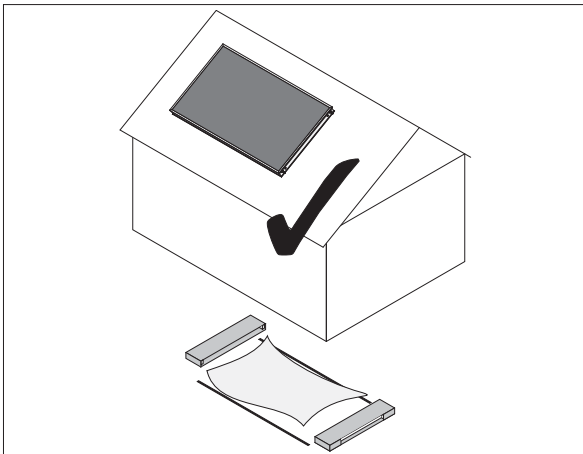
Kollektor nicht mit Folie auf dem Dach montieren
